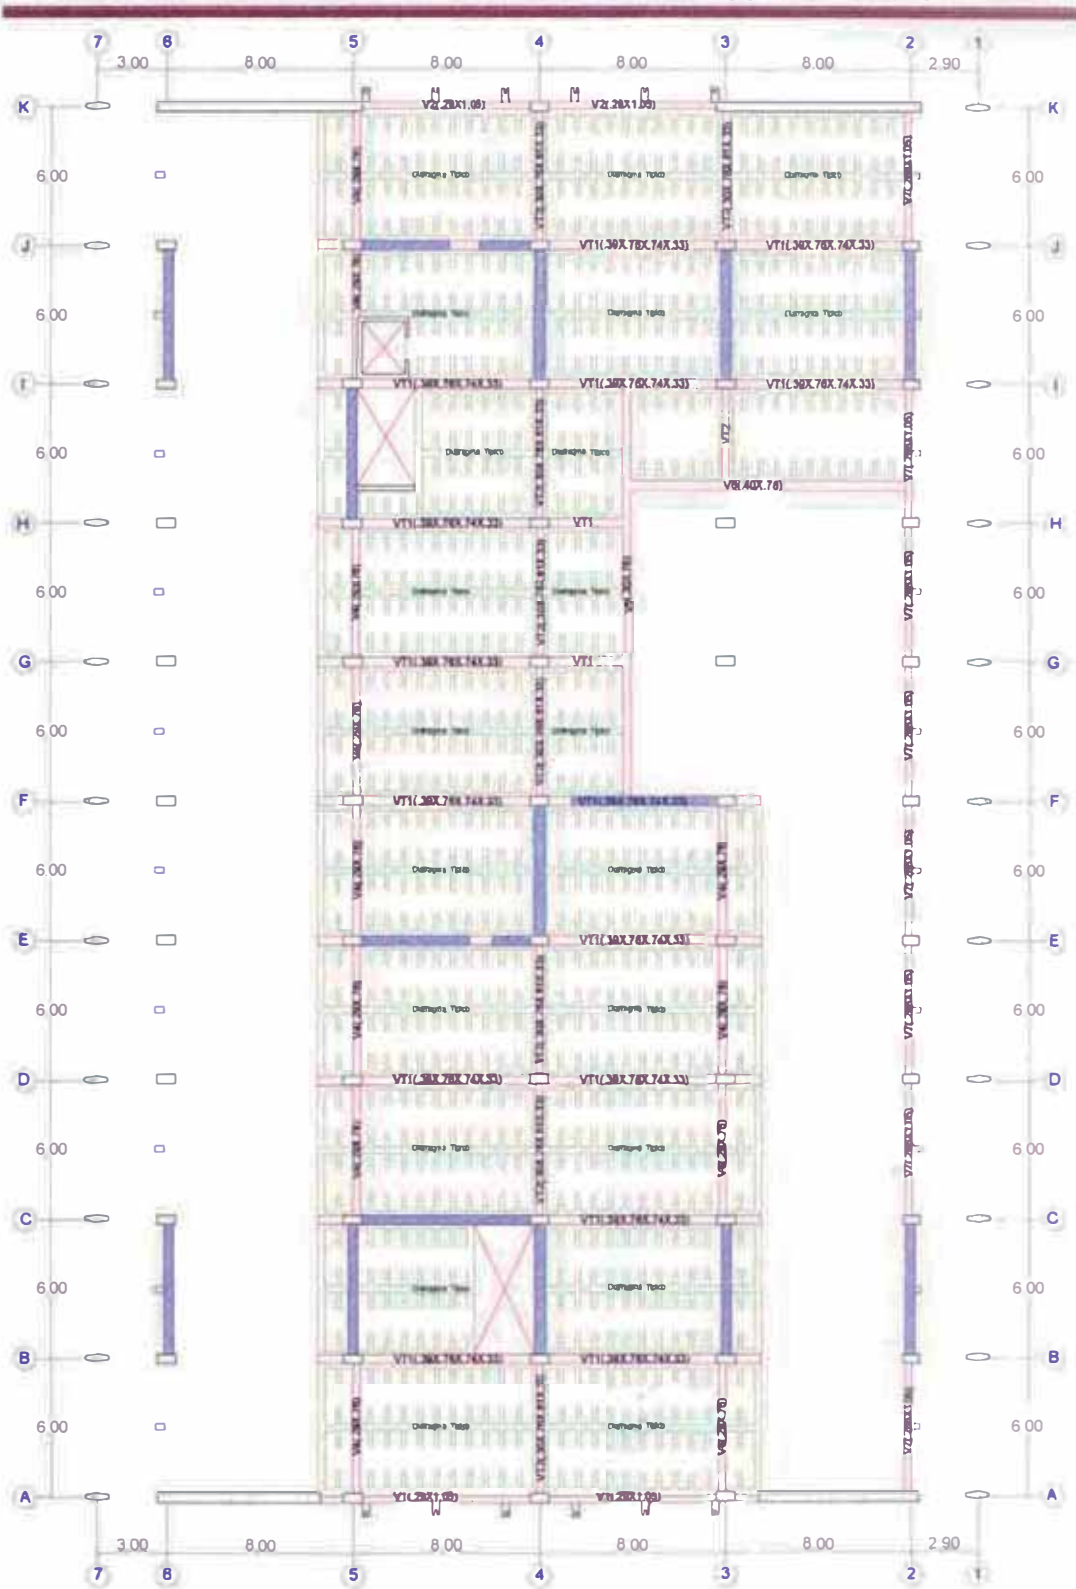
Vista en planta de losa de techo del segundo piso (primer mezaninne).
